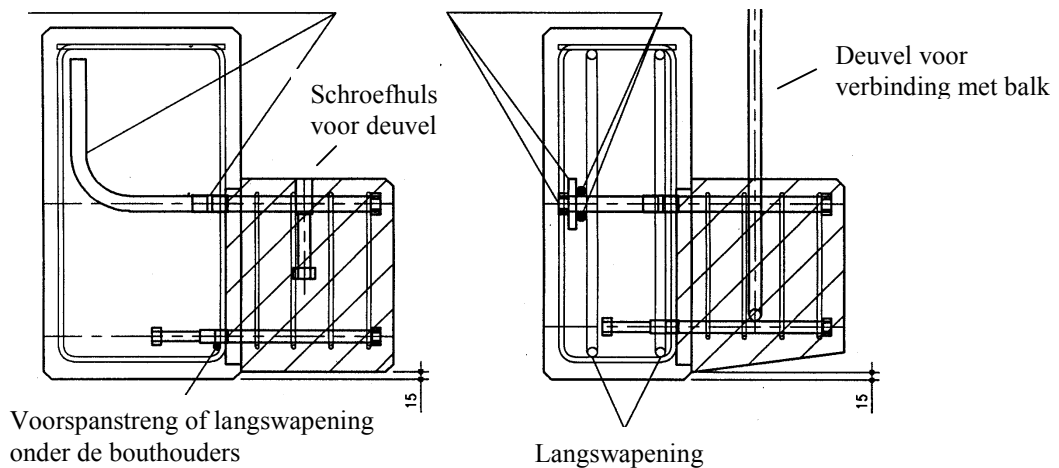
Voorbeeld van wapening bij balkconsoles
